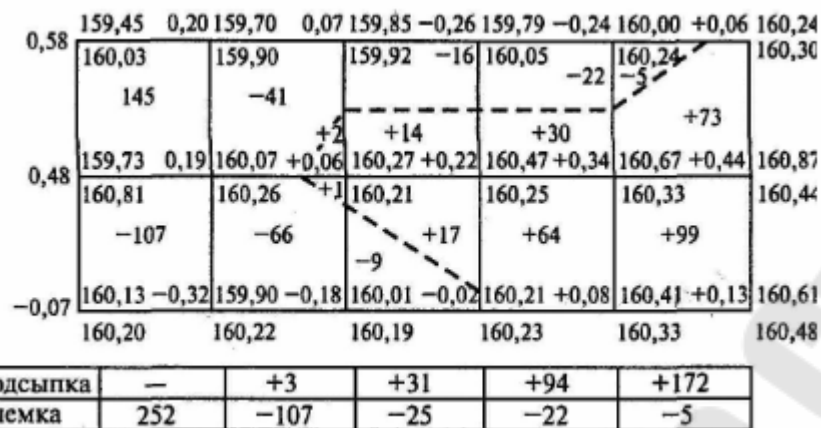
План перемещаемых земляных масс с таблицей баланса
